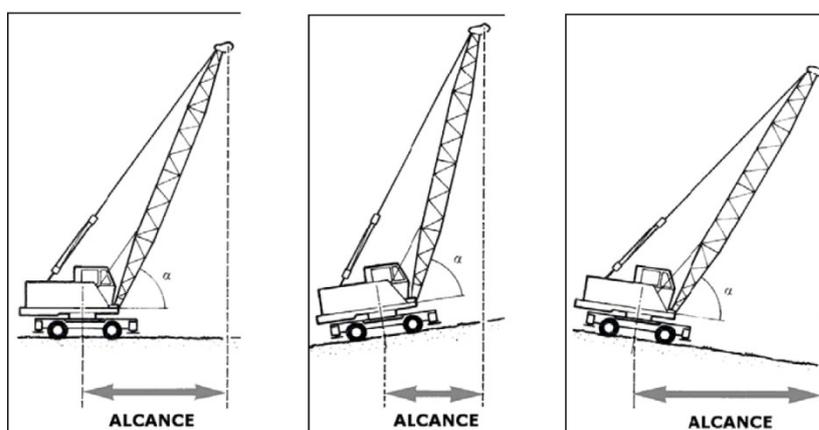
Esquema dos vários planos da grua (REN, 2008. Fichas de Prevenção e Segurança)
